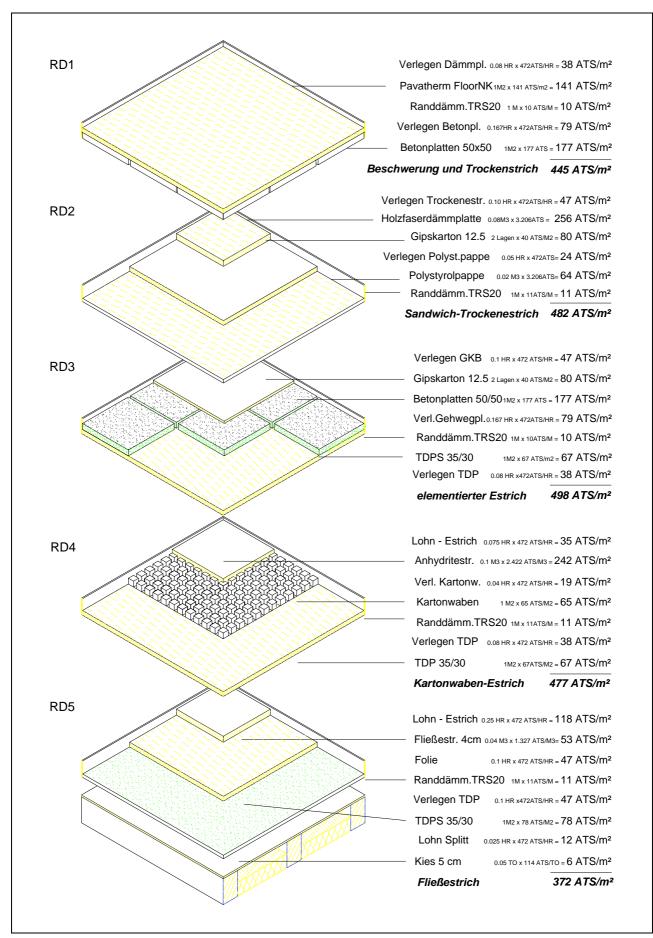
Rohdecke und Fußbodenaufbau für RD1, RD2, RD3, RD4,
